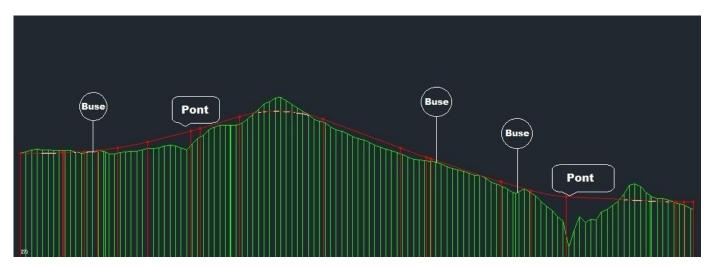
Représentation des ouvrages hydrauliques sur le profil en long.
